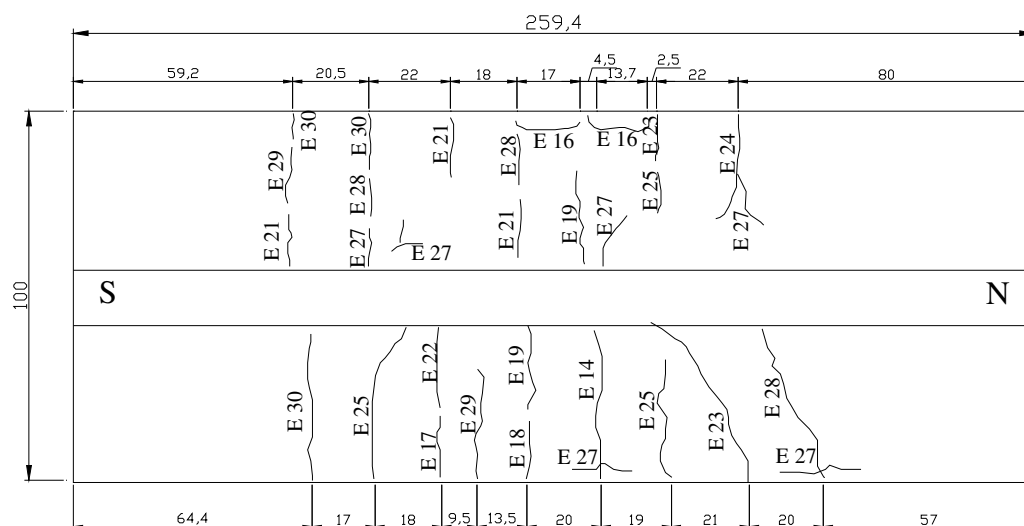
Fissuras do modelo 4A (face inferior da laje) – medidas em cm.
